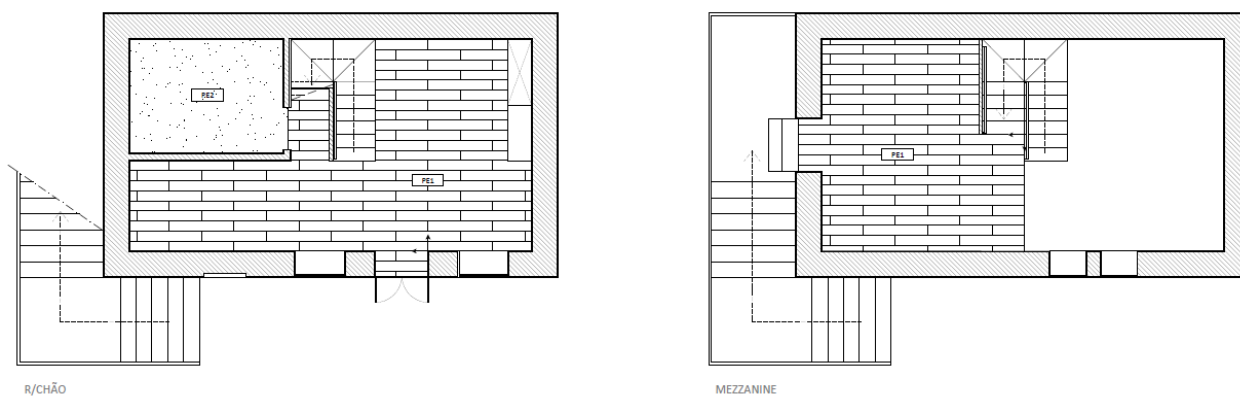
Planta de Pavimento, Alojamento Til, Piso 1.
